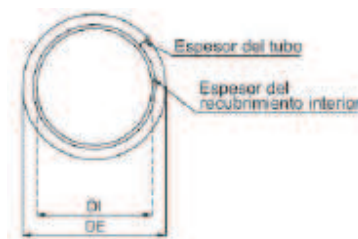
Sección transversal de tubería de conducción. Fuente: ENOHSA.
